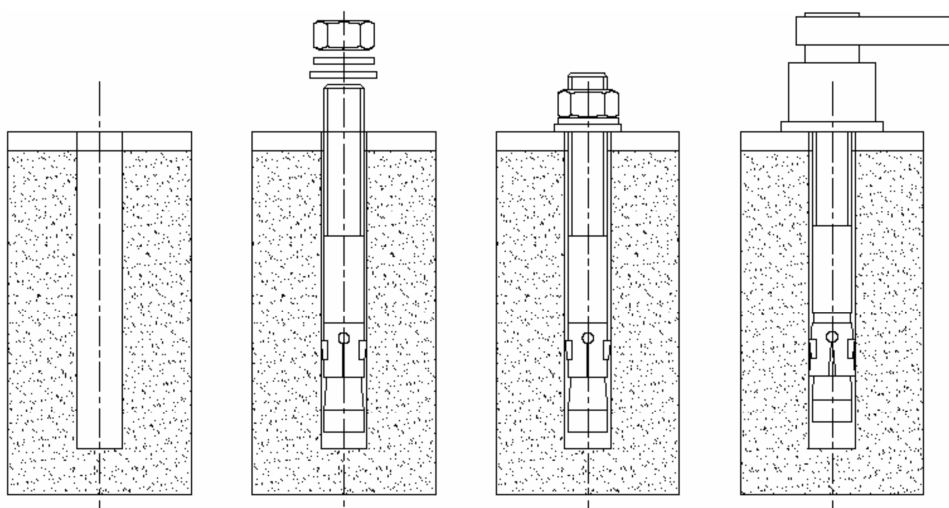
Крепление кронштейна к стене на дюбелях
